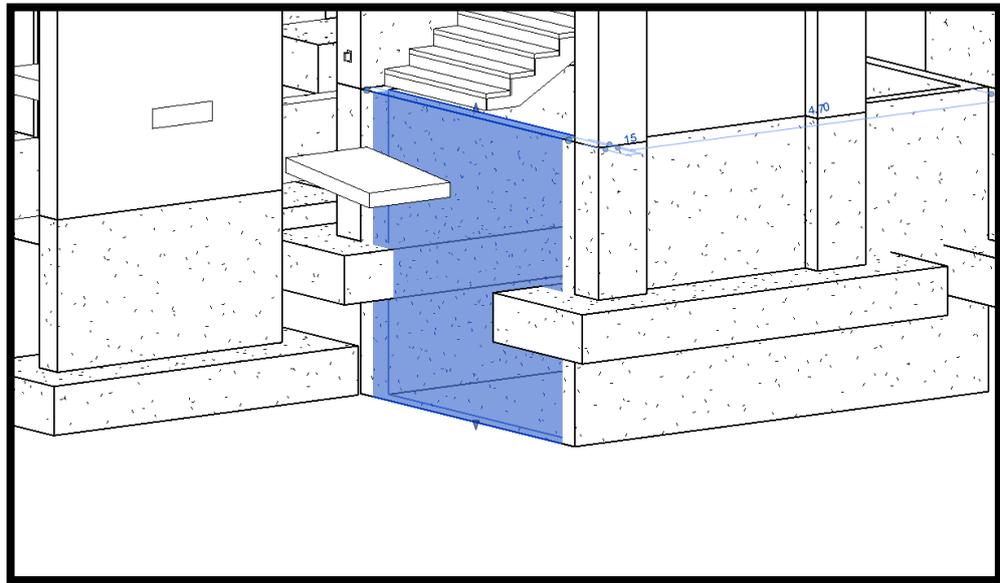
Captura de pantalla de Revit® 2014, vista en 3D del modelo BIM, donde se aprecia la ubicación de la cisterna cortando la cimentación de las placas PL-05. Fuente: Propia
